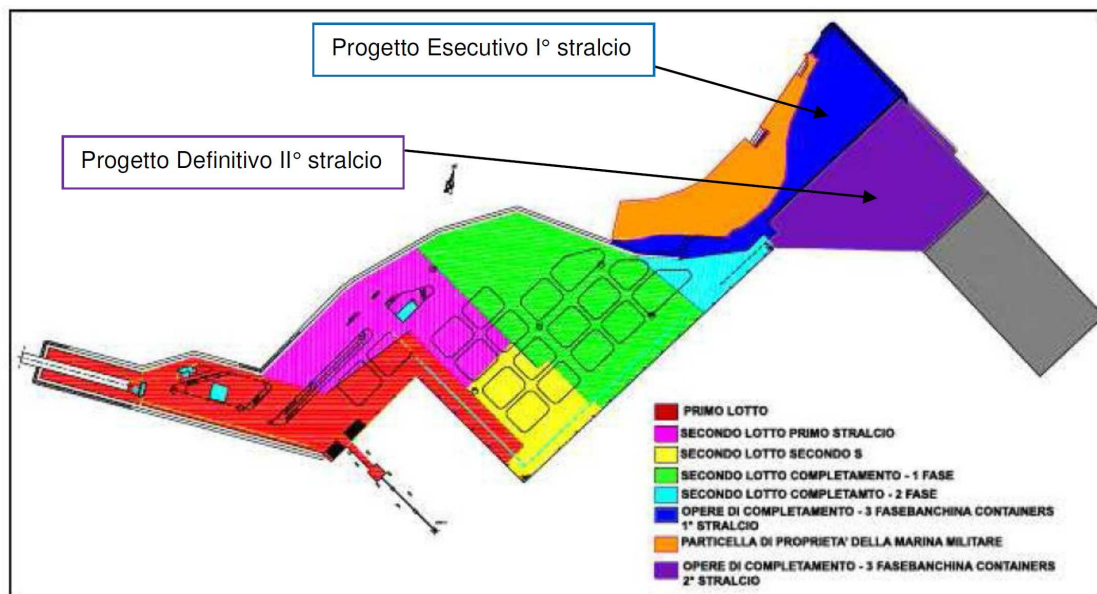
Planimetria del porto con indicazione dei lotti esecutivi e delle opere di completamento.
